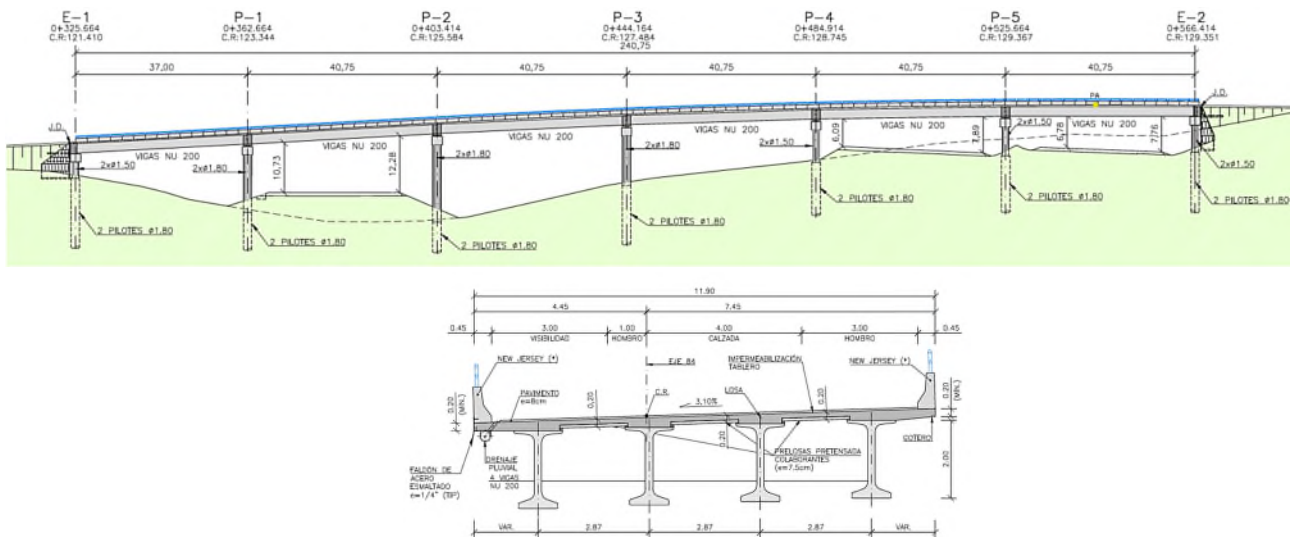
Alzado y sección del tablero de la estructura E-12. Paso superior con tablero de pequeño ancho
